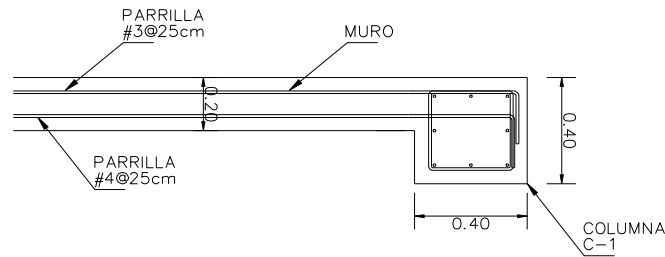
Detalle de muro y columna en cajón de cimentación
